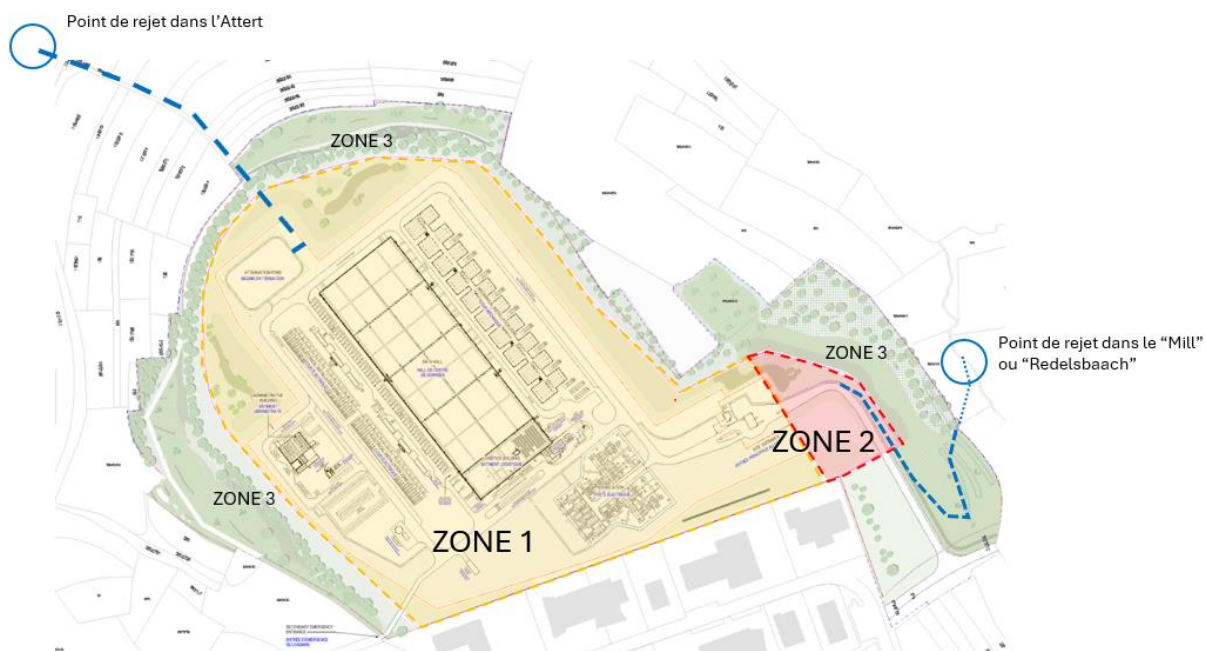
Plan des sous-bassins versants prévus sur le site du projet (Source : London Bridge Technology, 2024)
